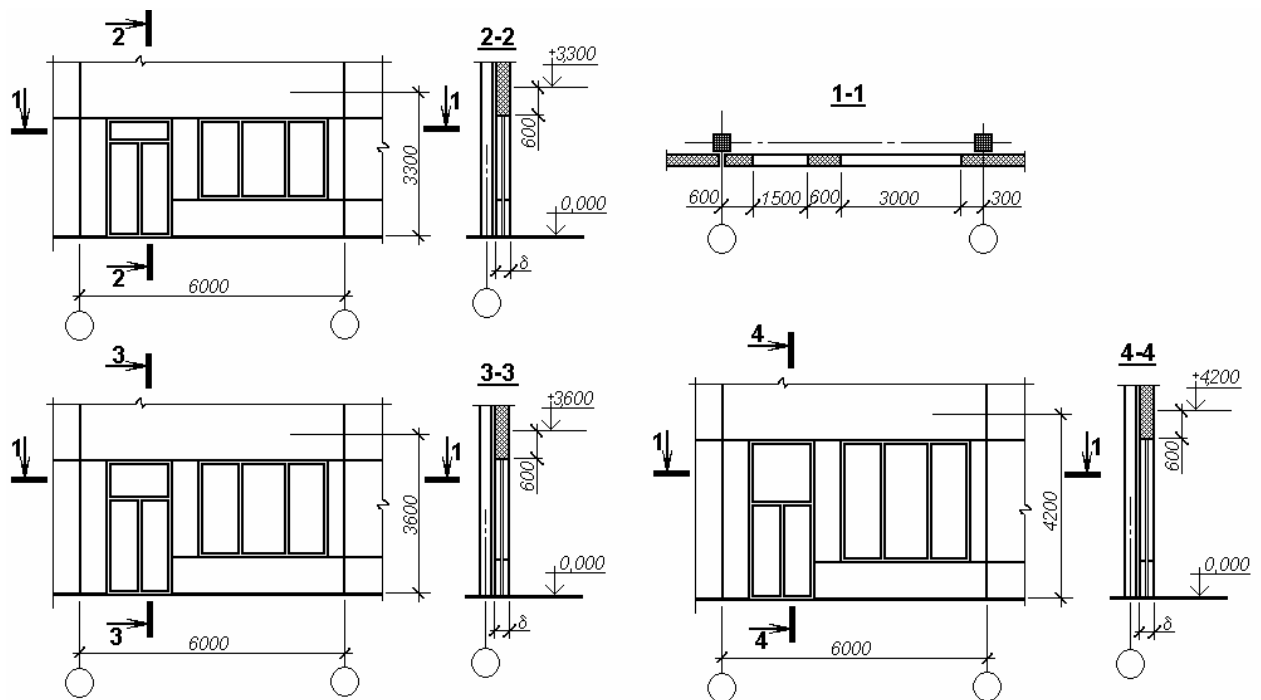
Схемы разрезки и компоновки панелей наружных стен у входов в здание.
